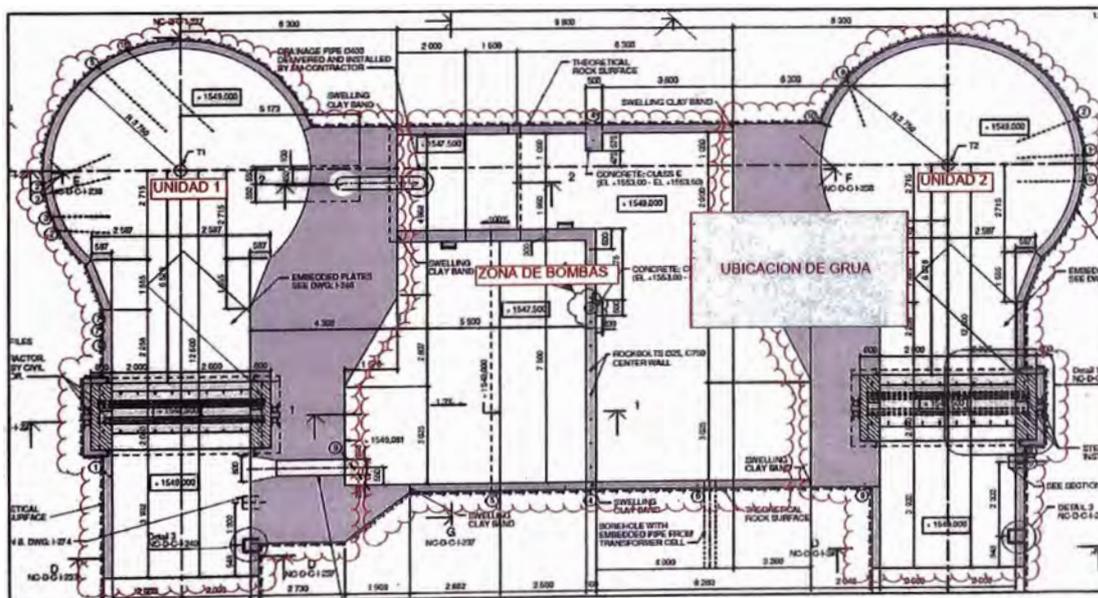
Zonas de trabajo – Planta nivel 0
